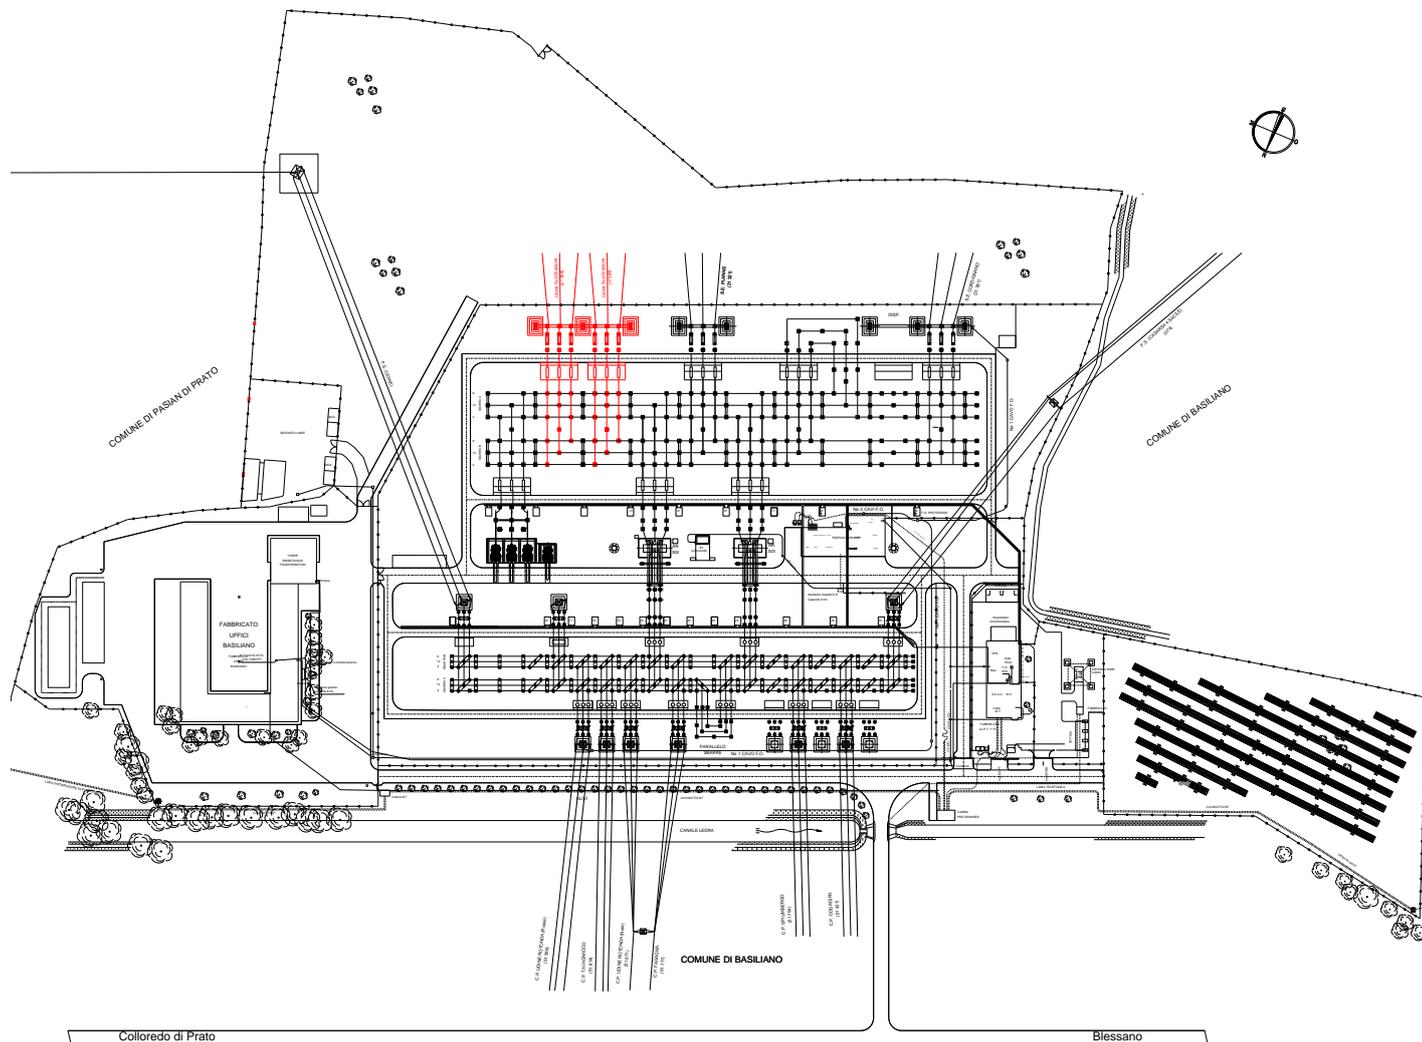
Planimetria di stazione - Nuovi stalli 380 kV
